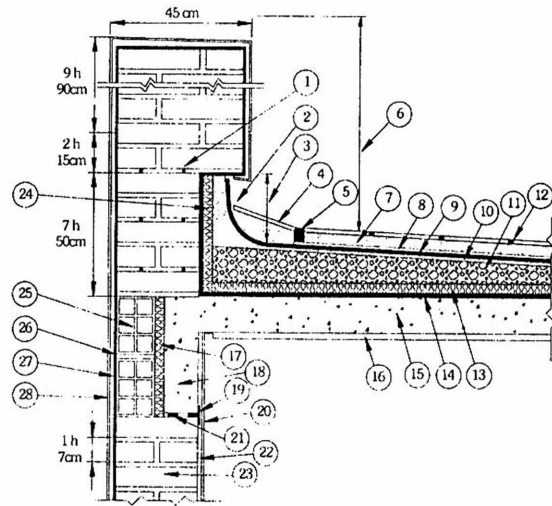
Cubierta plana (encuentro con parapeto).
